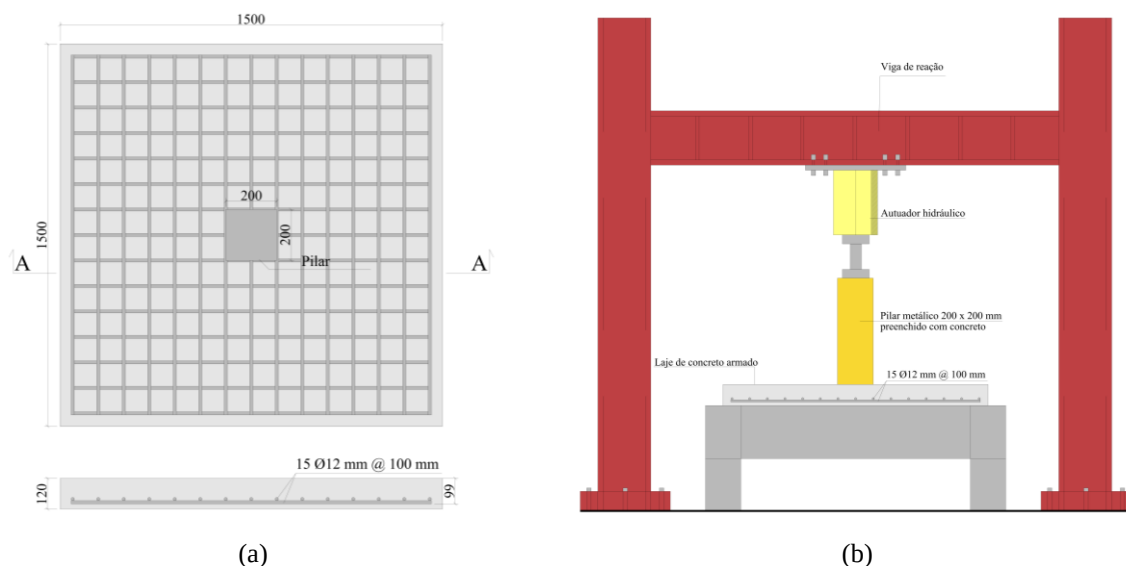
(a) Geometria das lajes ensaiadas e (b) sistema de ensaio (adaptado de Sahoo e Singh (2020)).
